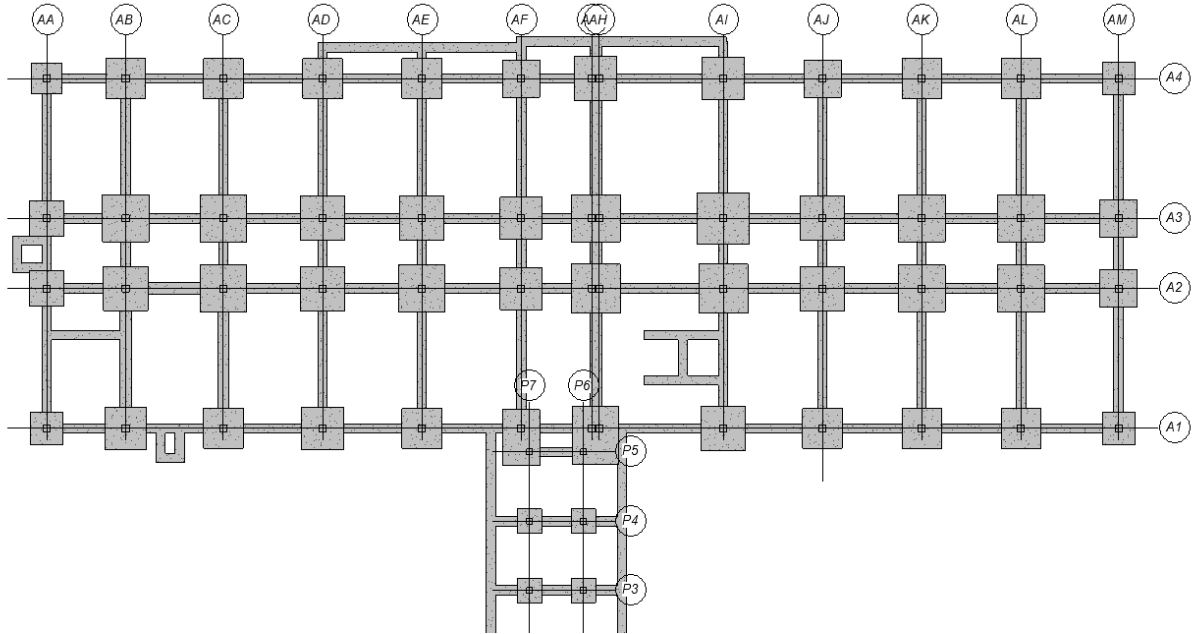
Vista en planta de la cimentación del Aulario y suentrada desde el patio
